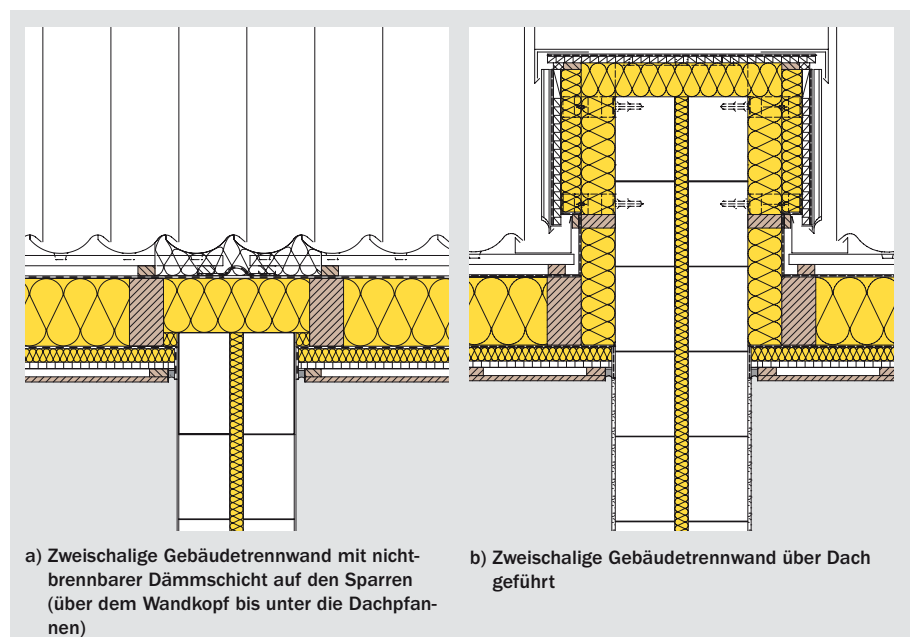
Gebäudeabschlusswand aus Kalksandstein-Mauerwerk im Dachbereich
